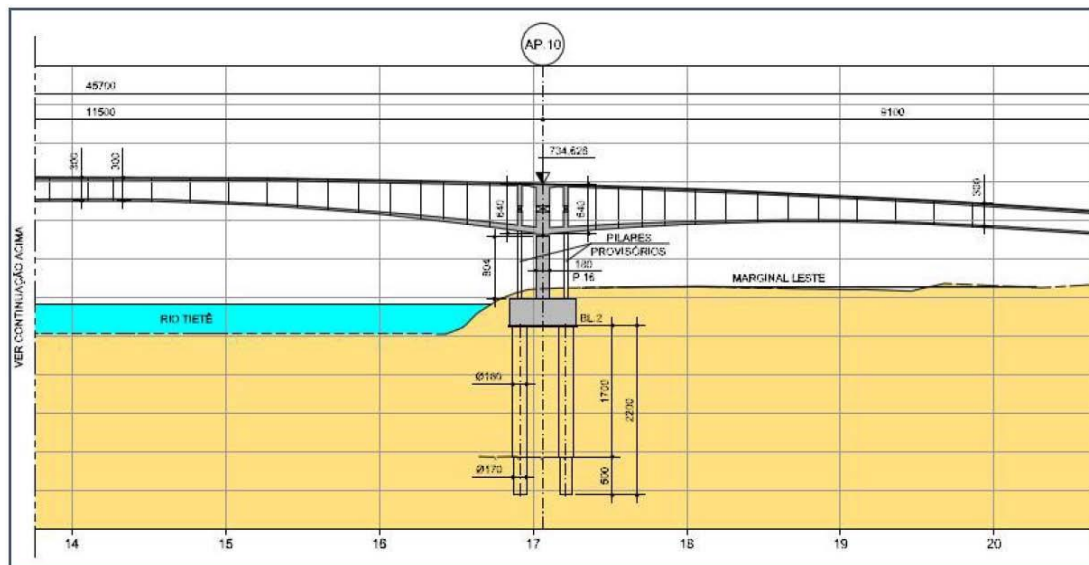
Perfil longitudinal da OAE – pista direita 3/4.
